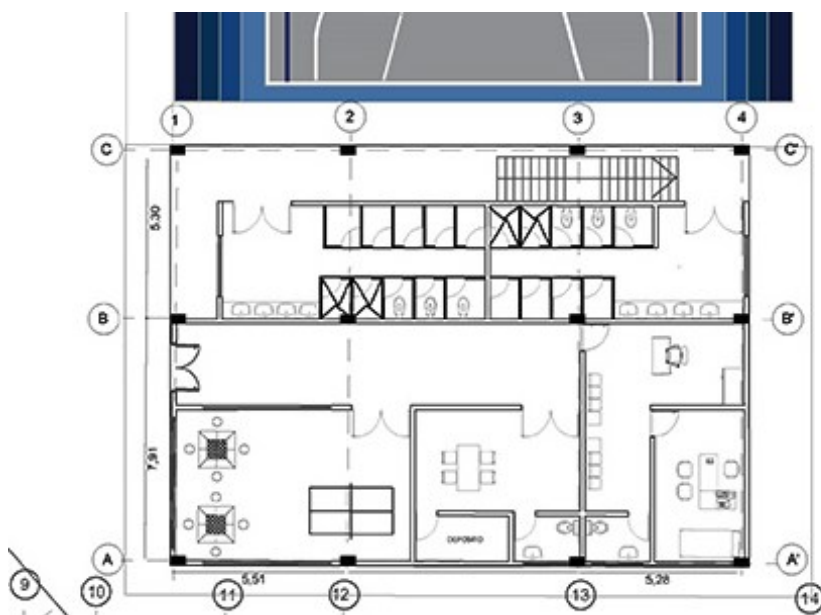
Planta 1er piso bloque de bienestar. Fuente: Elaboración propia.
